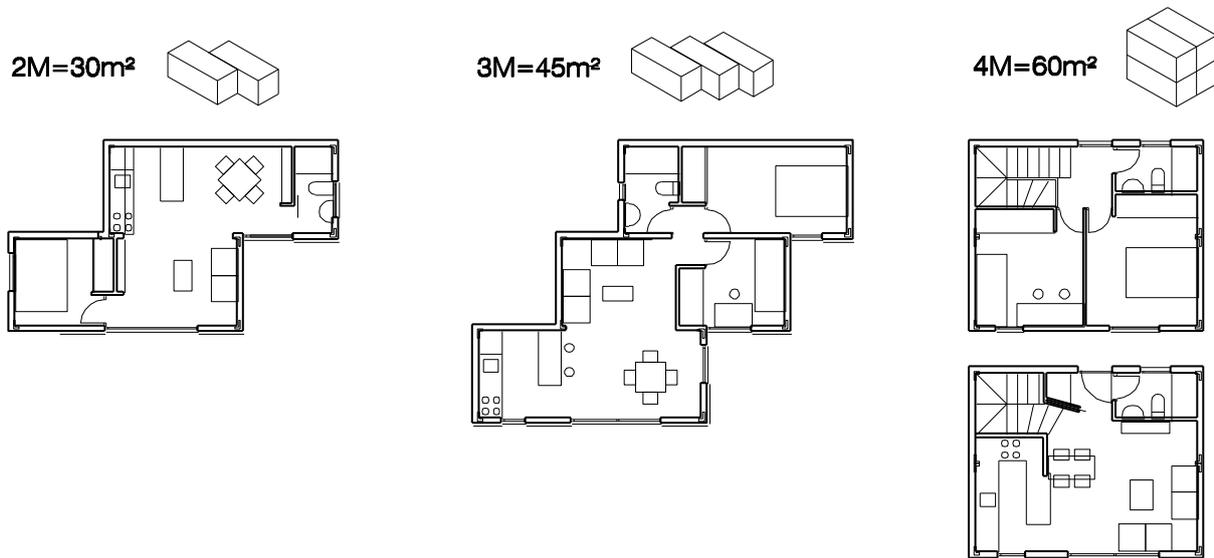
Ejemplos de plantas de viviendas de 2, 3 y 4 módulos.
